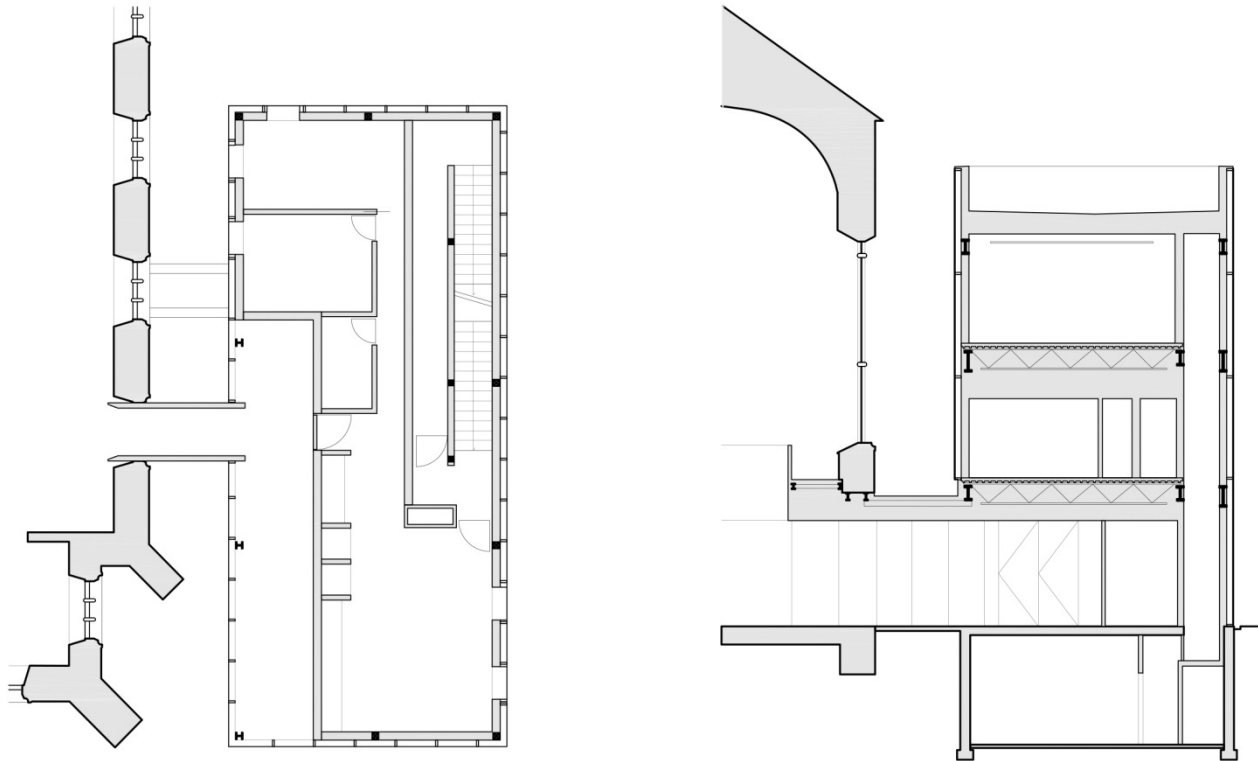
Maison de la littérature, Coordination, 20 novembre 2012. Plan du 1er étage et coupe transversale.
